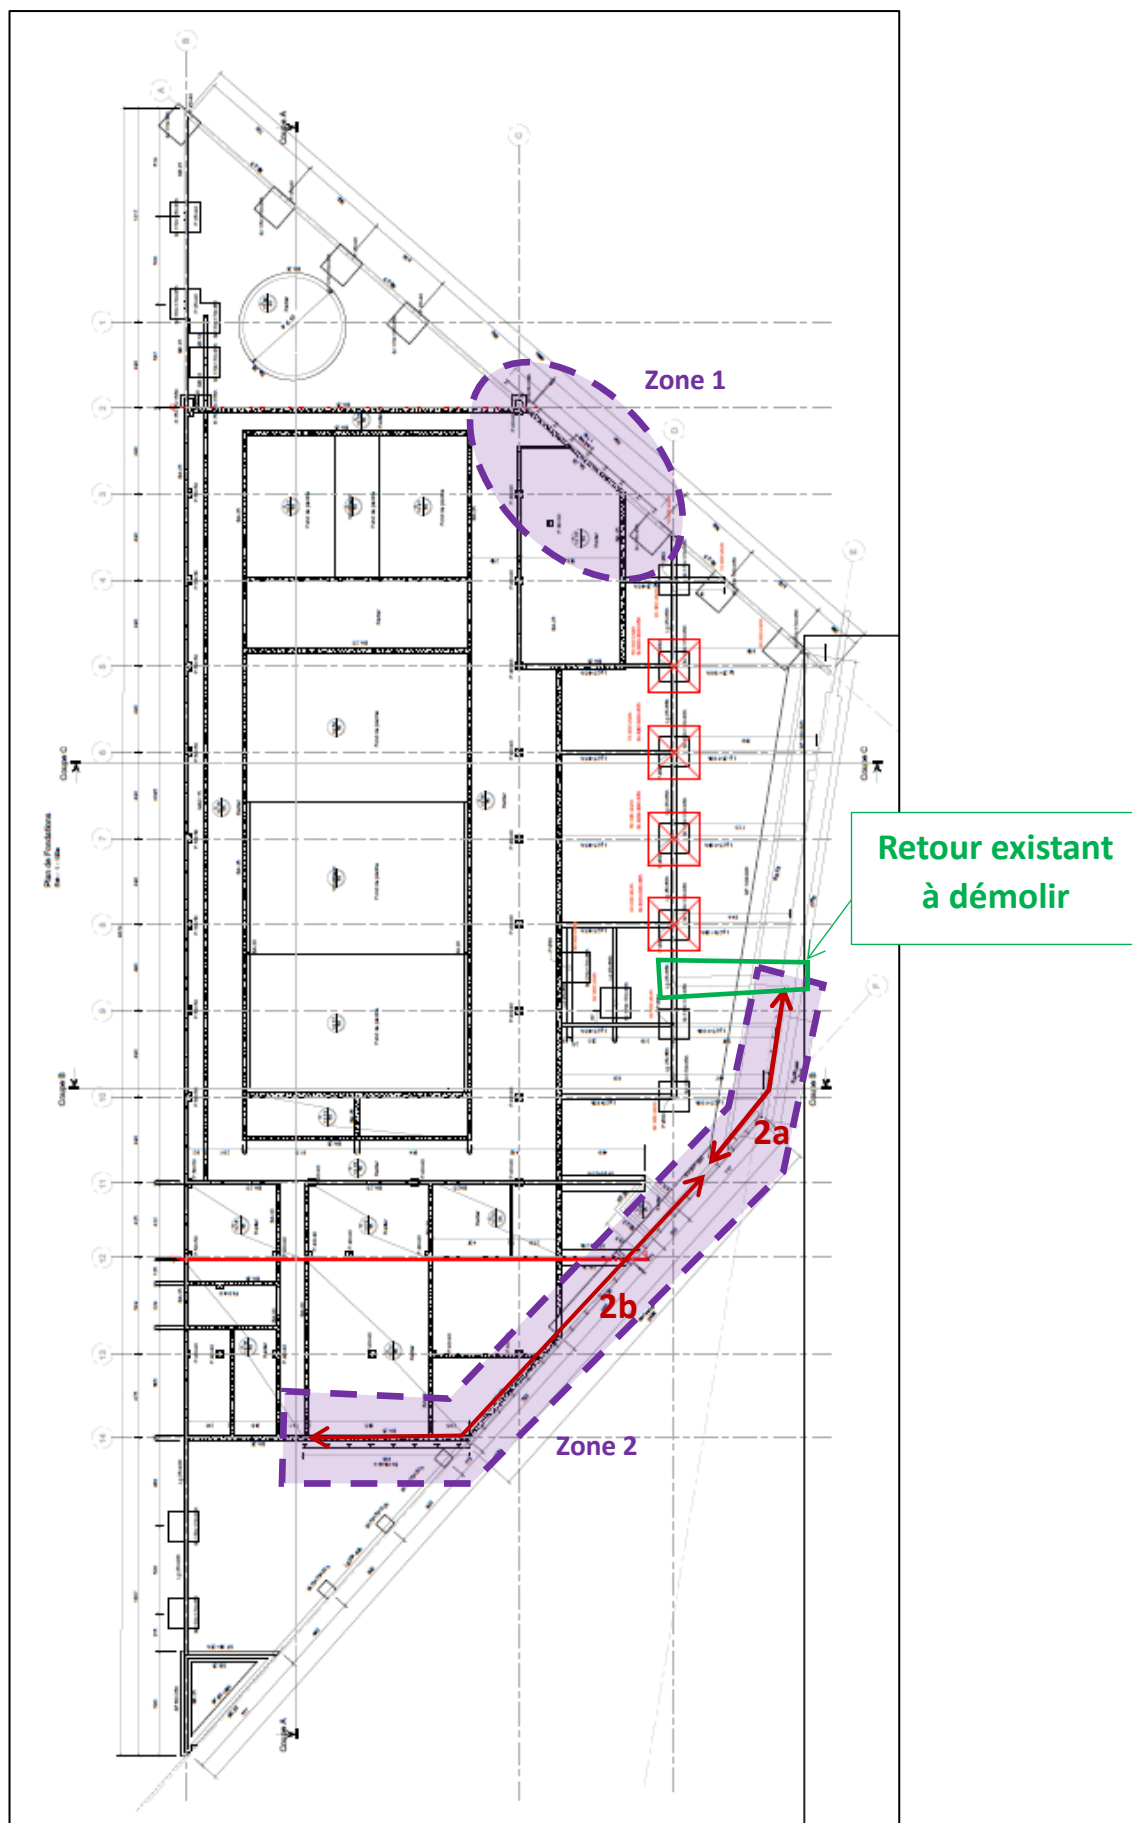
Localisation des écrans de soutènements sur plan de fondations n°2101 PRO de Mars 2025
